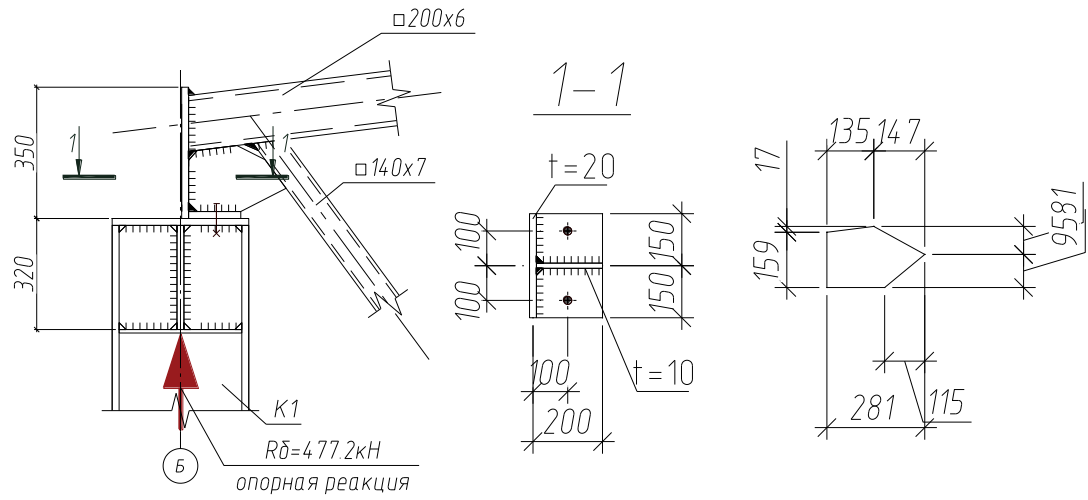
Узел 1. Опираение фермы на колонну
